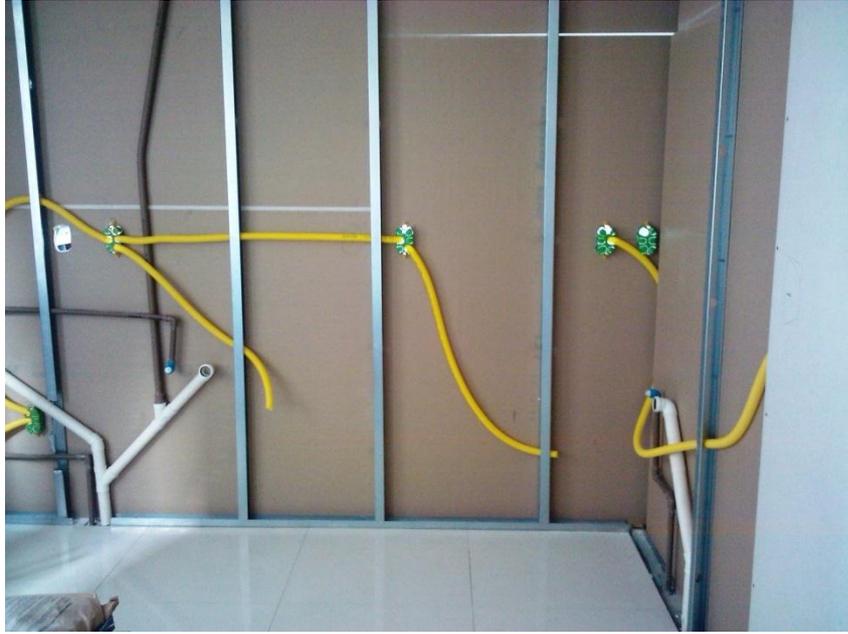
Ilustração dos Instalação Elétrica do Drywall
